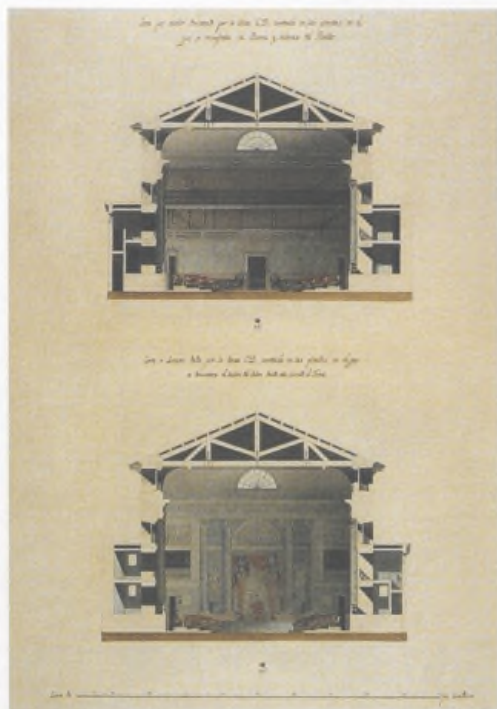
Proyecto para el Salón de Cortes. Secciones transversales. Madrid. Biblioteca Nacional.
